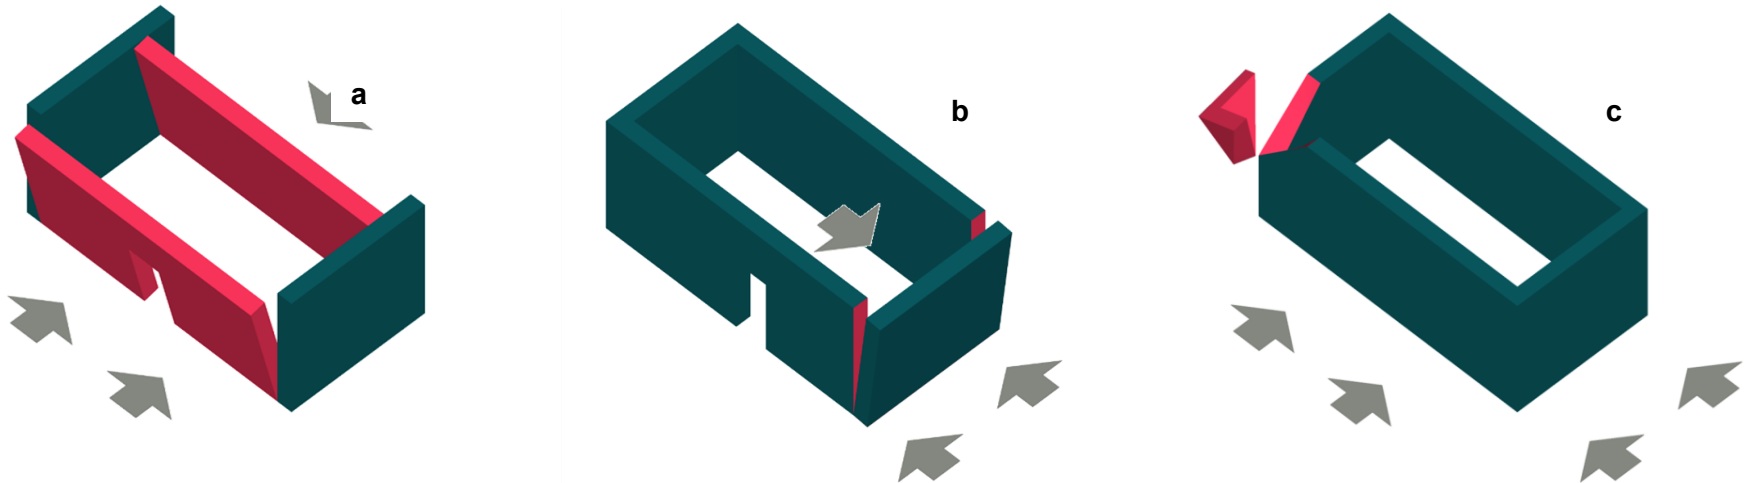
a) Colapso por falta de anclaje entre las paredes y los diafragmas horizontales. b) Colapso de muros cortos fuera del plano c) Colapso fuera del plano en es-quina Fuente: Elaboración propia en base a Paulo Lorenço.
